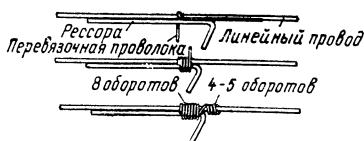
Устройство рессоры для образования искрового промежутка
